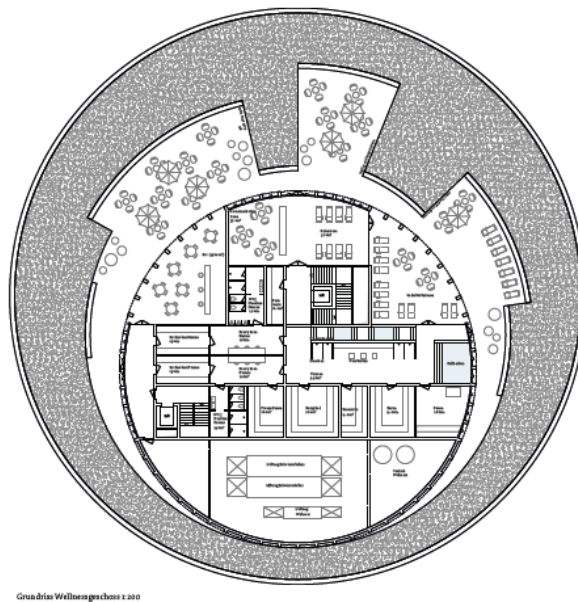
Grundriss Wellnessgeschoss (ohne Masstab)
